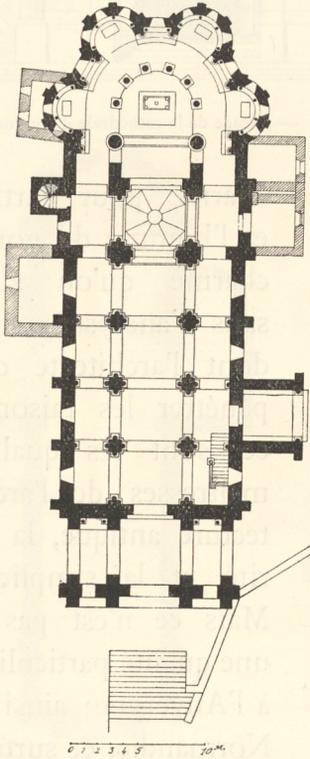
Église de Châtel-Montagne (Allier). Plan.
